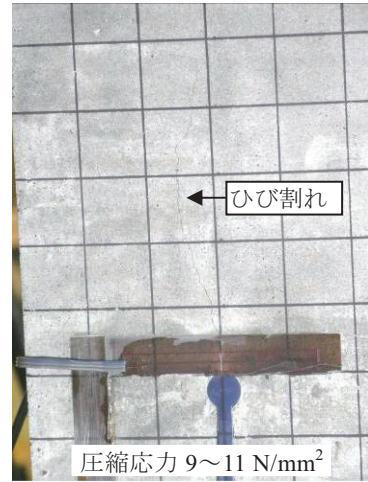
供試体4の荷重途中のひび割れ発生状況
